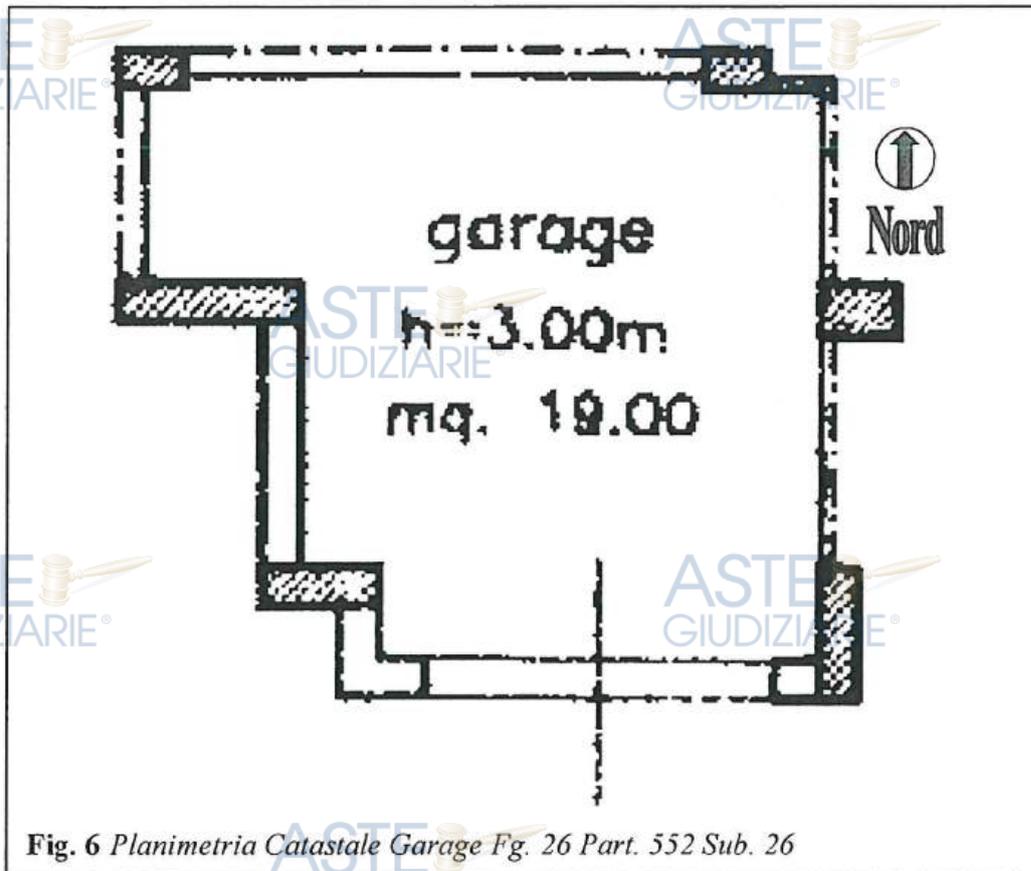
Planimetria Catastale Garage Fg. 26 Part. 552 Sub. 26
